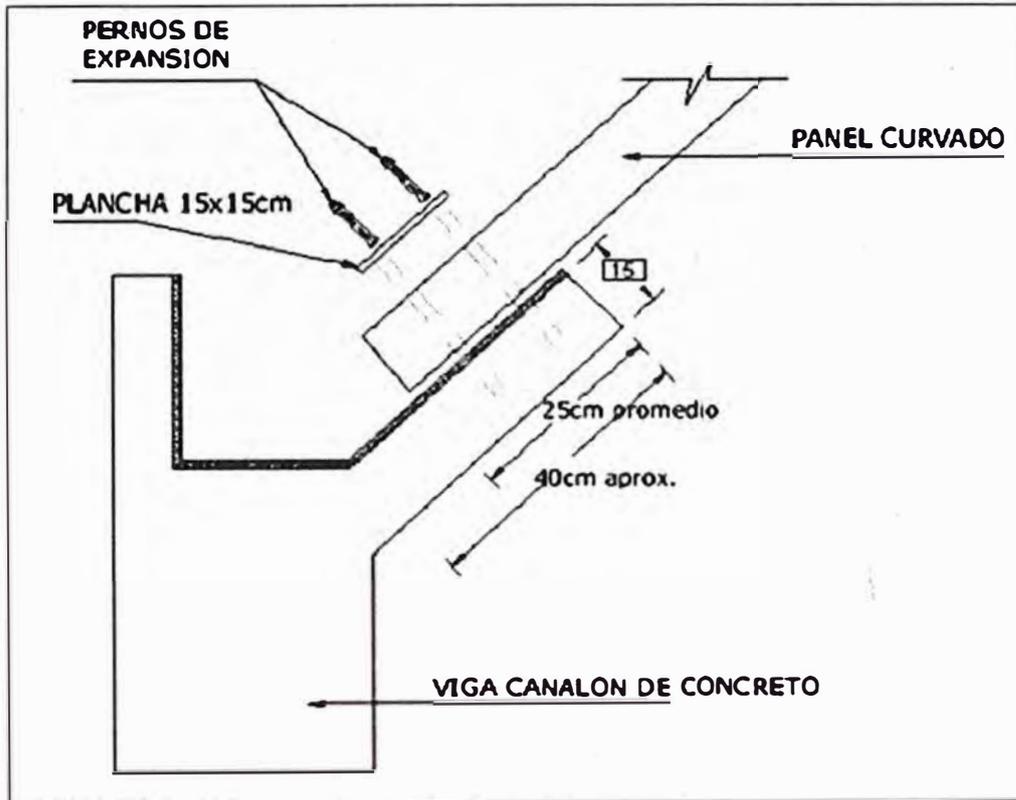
Anclaje en viga de concreto (Referencia 3)
